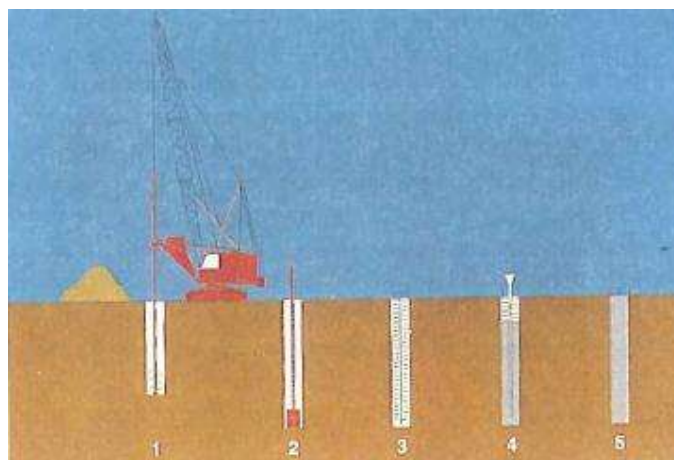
Proceso de construcción de pilotes de concreto *in situ*. Vallejo, 2004.
